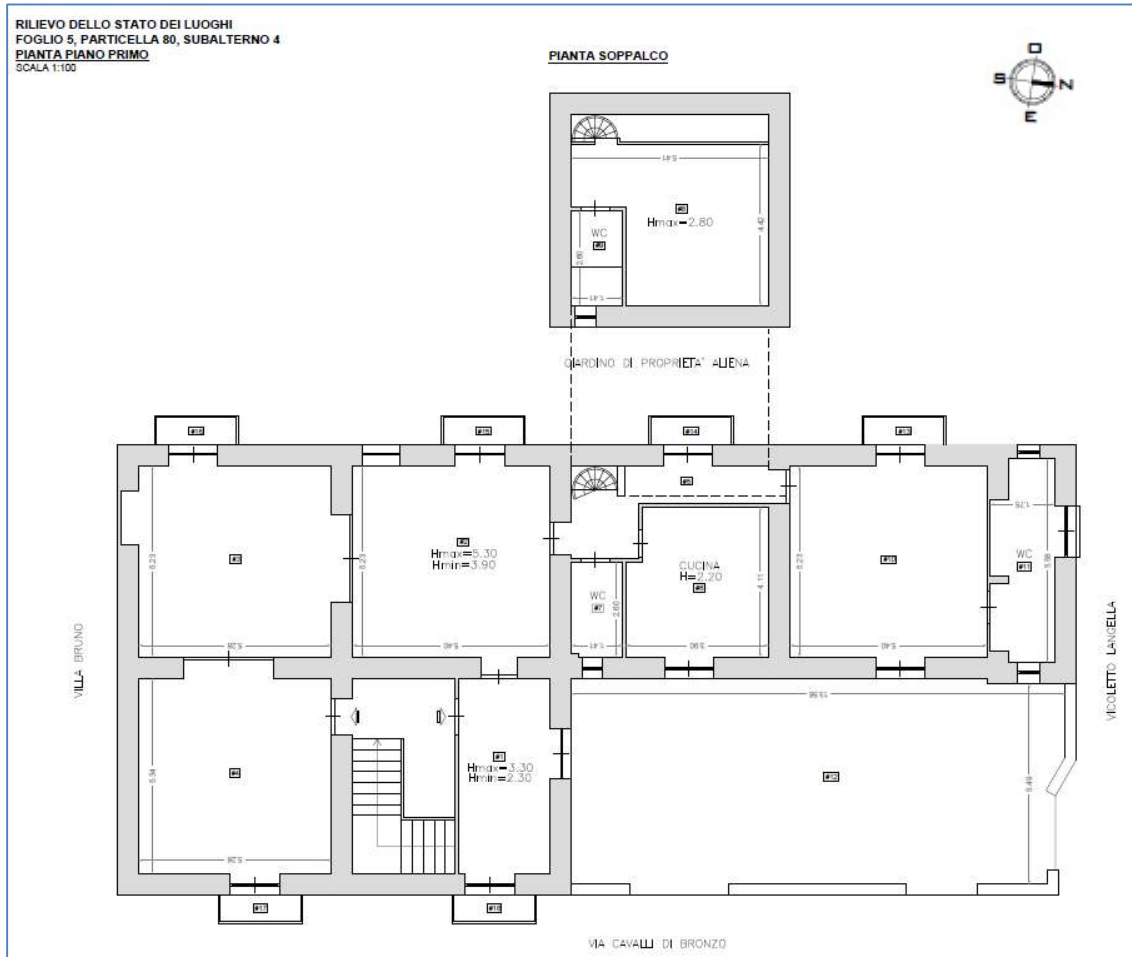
Rilievo planimetrico dell'unità immobiliare (cfr. tavola B-2).
